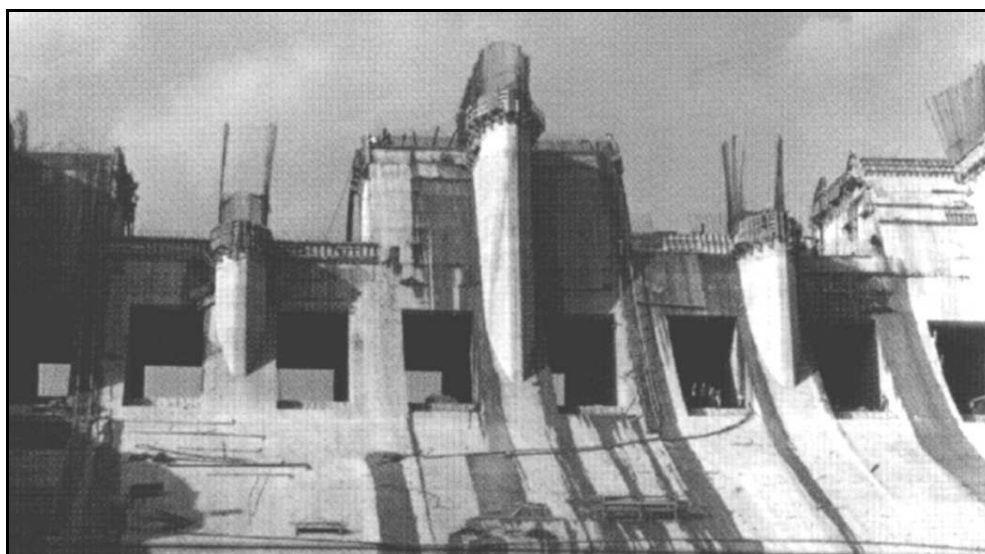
Vista da construção da UHE Marimbondo (FONTE: FURNAS).
